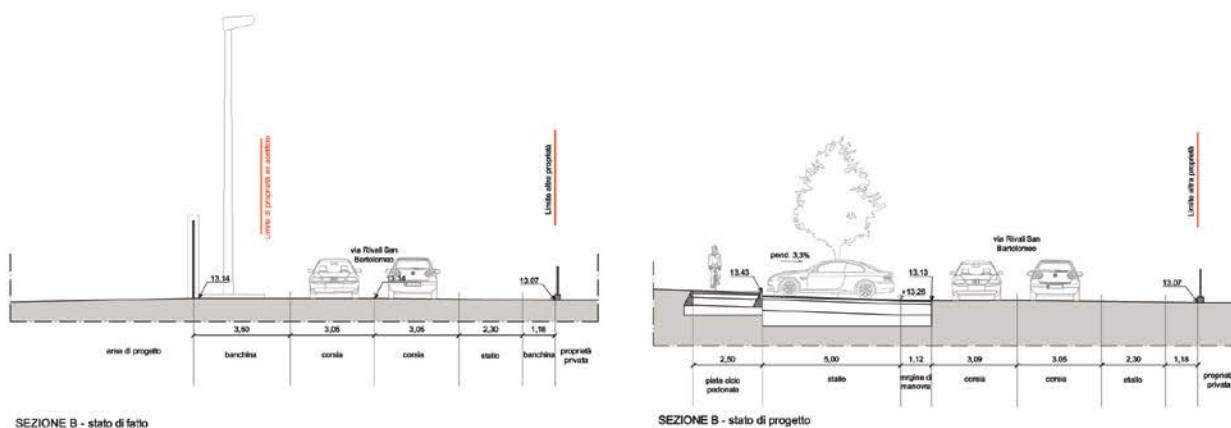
Sezione stradale dello stato di fatto e di progetto su via Rivali San Bartolomeo
